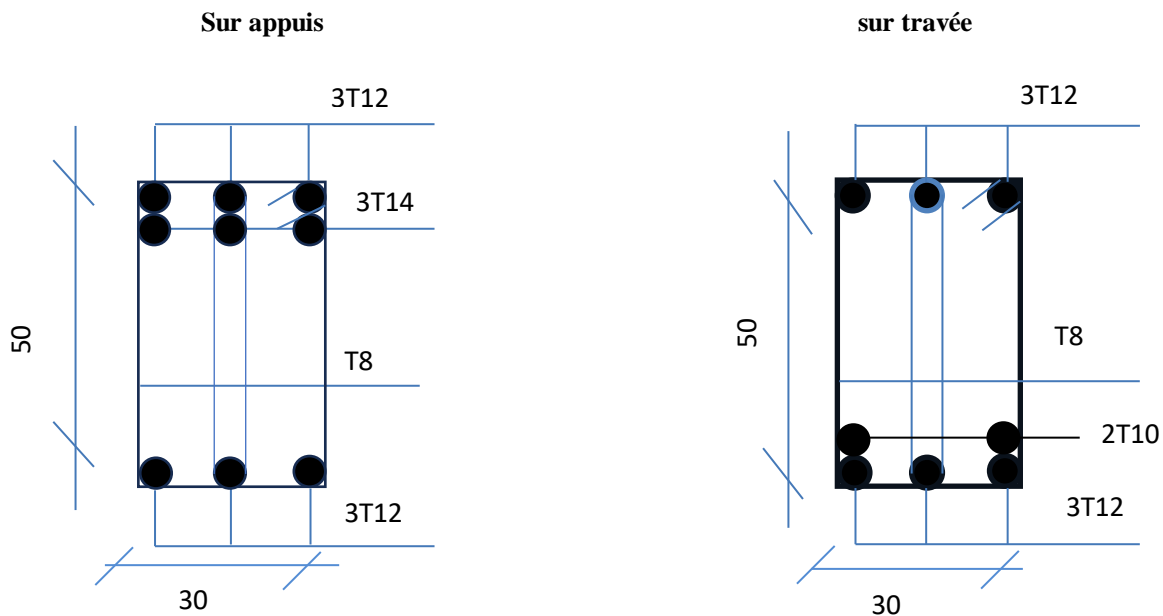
Coupe de ferrailage des poutres principales au niveau d'appuis et travée
